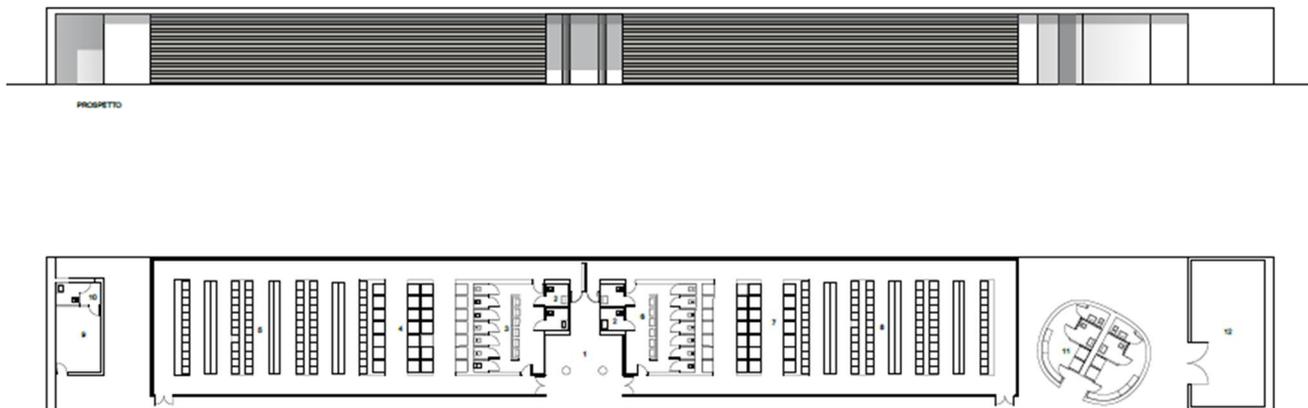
Planimetria e prospetto del corpo edilizio a servizio della piscina
